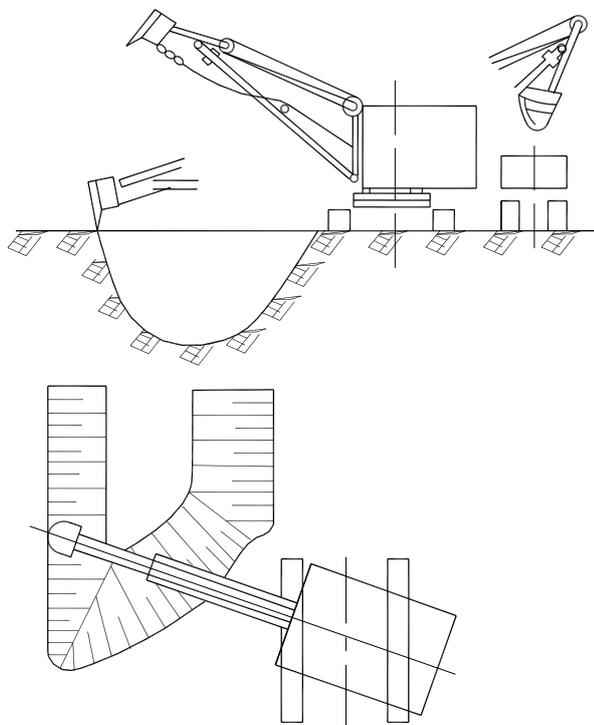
Технологическая схема при поперечной разработке выемки с погрузкой грунта в транспорт
